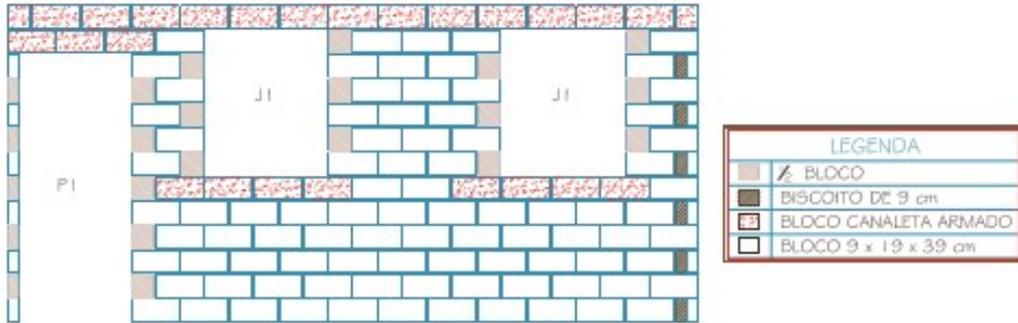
Detalhamento viga baldrame – Alvenaria Estrutural.
